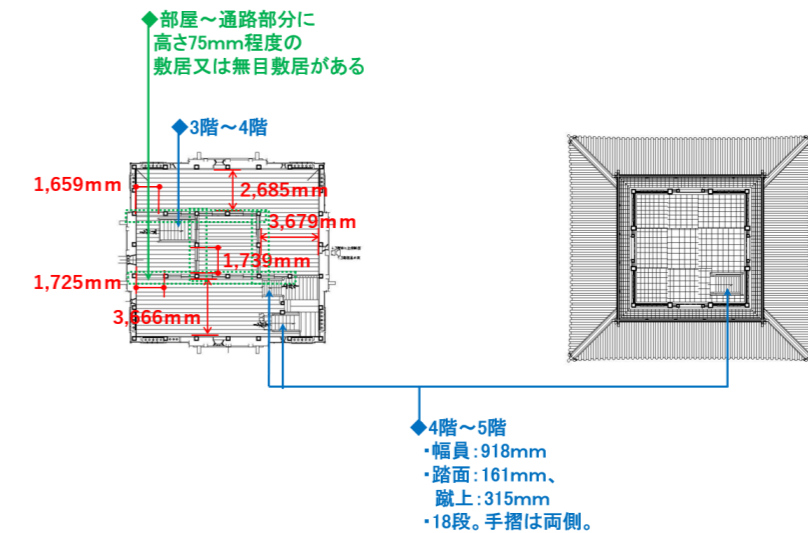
天守 4 階平面図及び天守 5 階平面図（復元原案）
